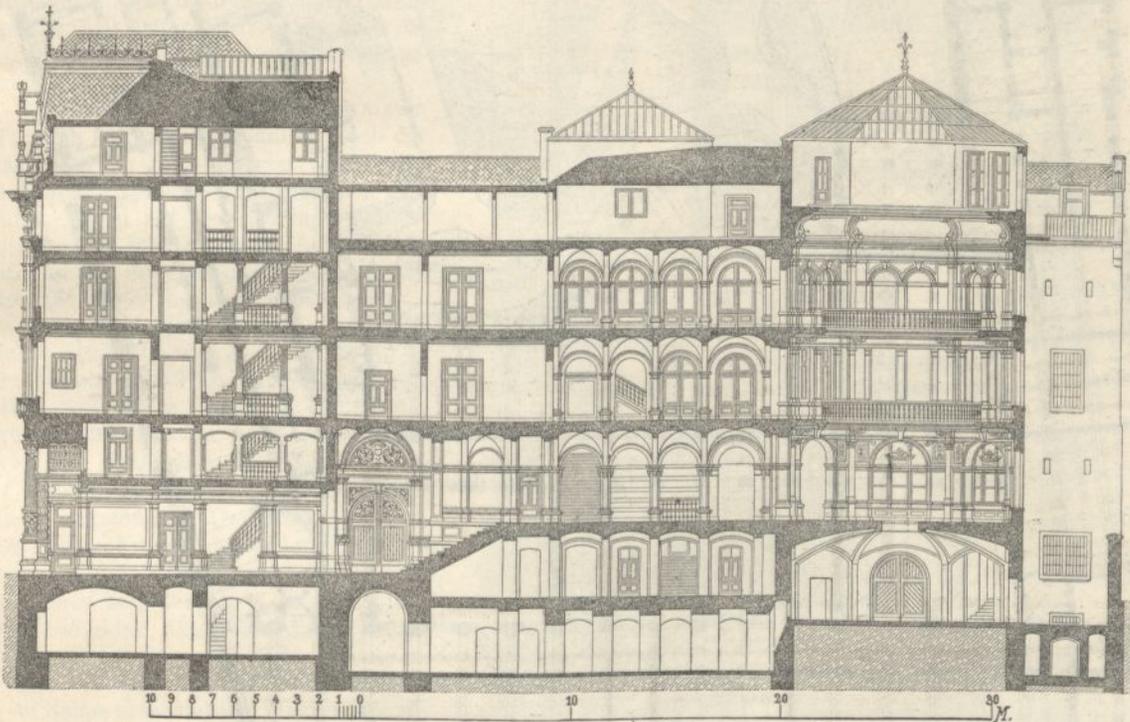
Bankgebäude in Frankfurt. Längenschnitt (Architekten Lin'emann & Strigler).
